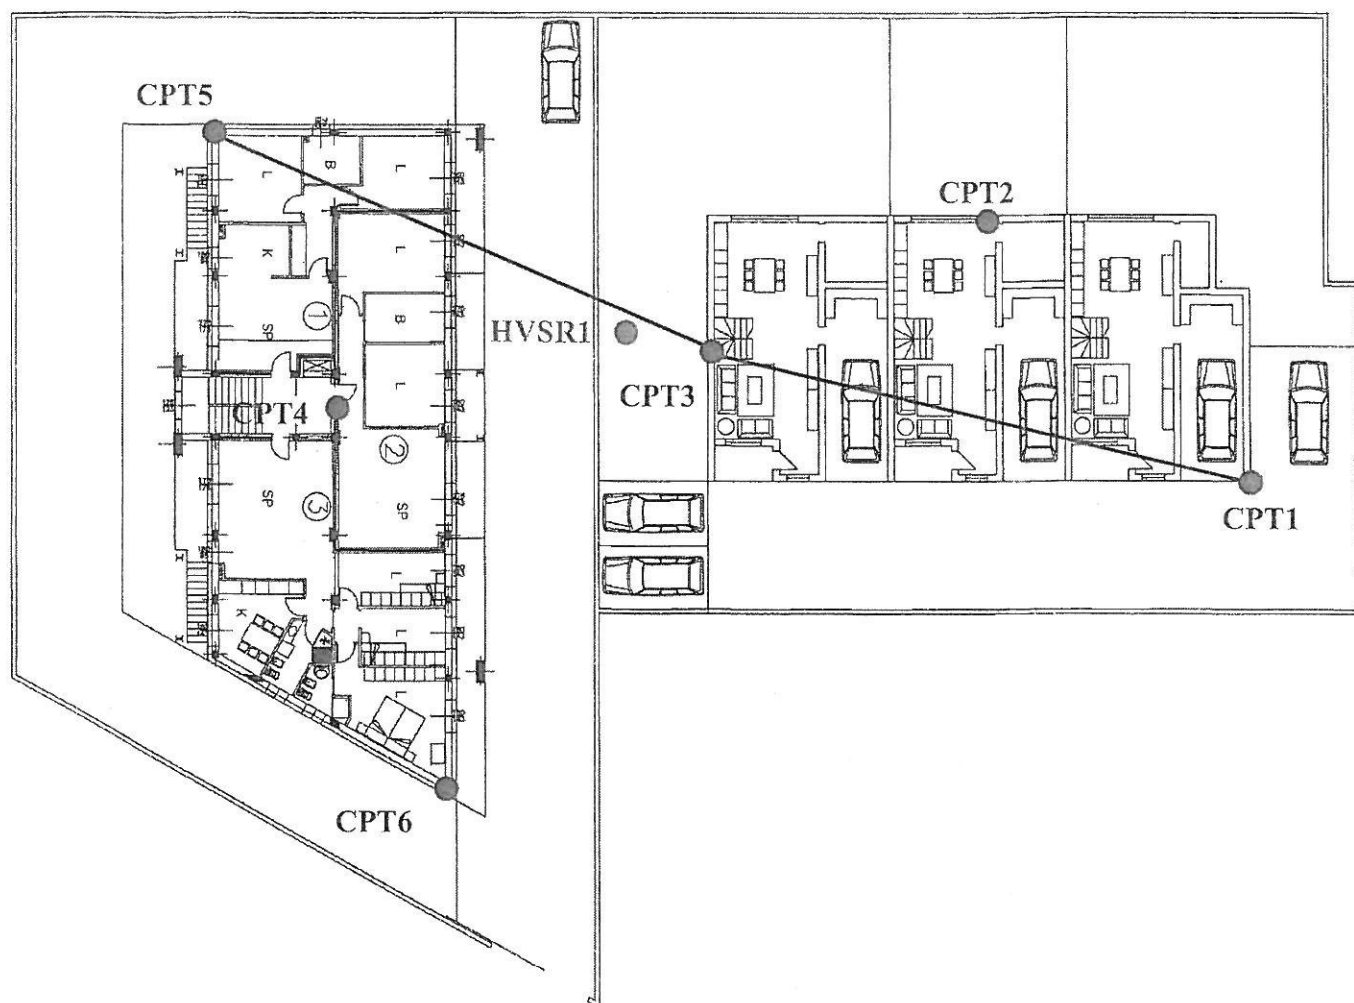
Schema ubicazione indagini geognostiche eseguite su planimetria di progetto
